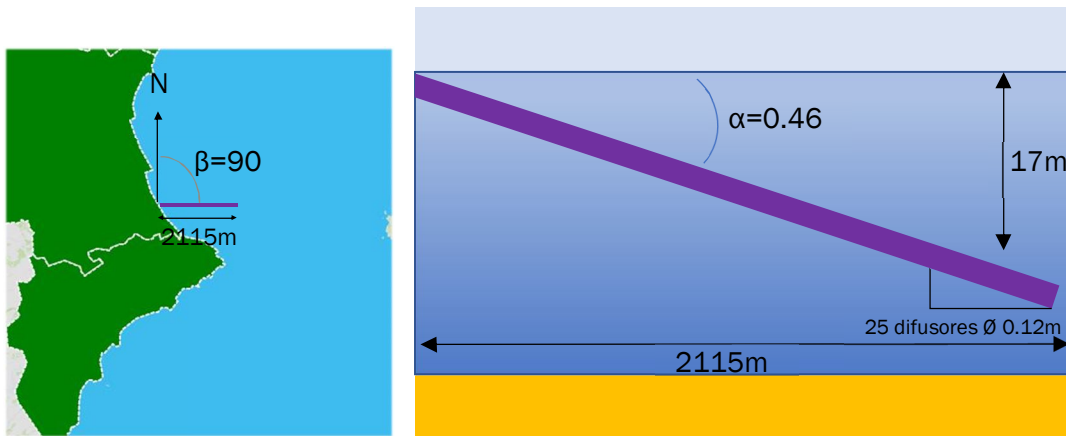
Vista en planta y perfil del esquema representativo del caso de estudio
